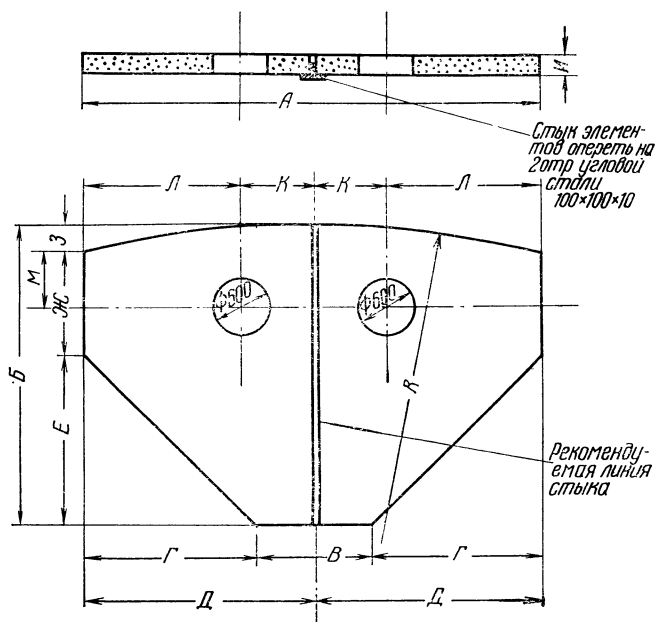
Сборное железобетонное перекрытие для типовых станционных кирпичных колодцев на 6, 10 и 20 тыс. номеров
